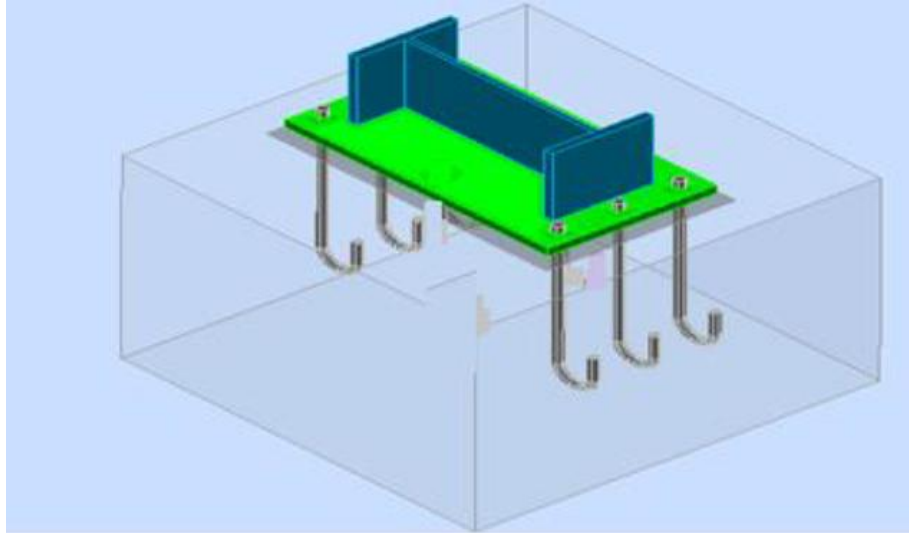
Vue en 3D du pied de poteau encastré.
